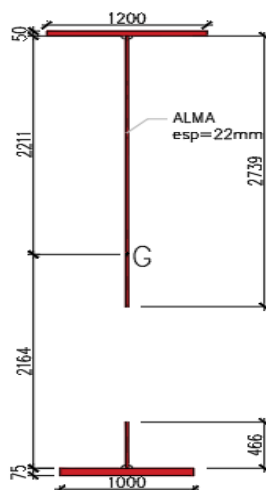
Dimensões da secção metálica efectiva – zona do apoio interno [mm]
